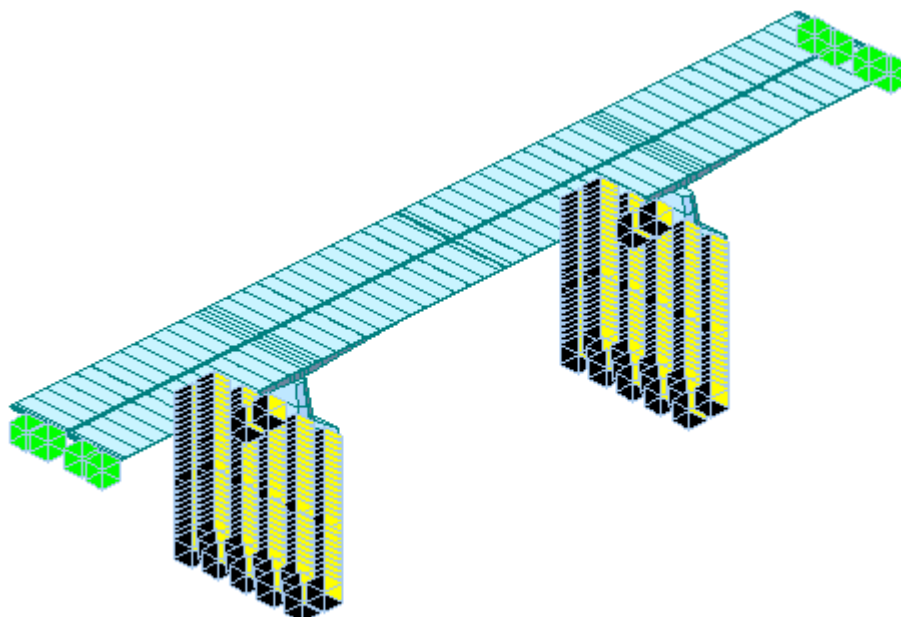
Condizioni al contorno applicate ai pali di fondazione e spalle
